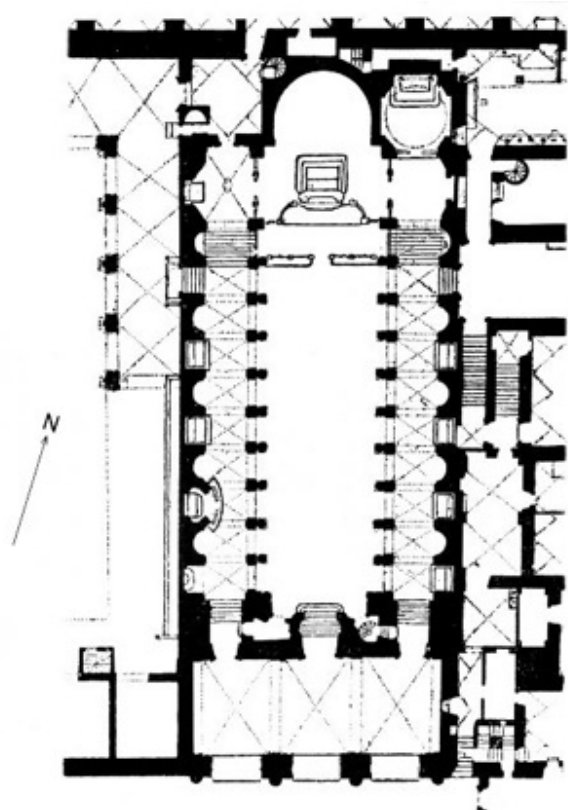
Rom, S. Marco Grundriss um 1900
